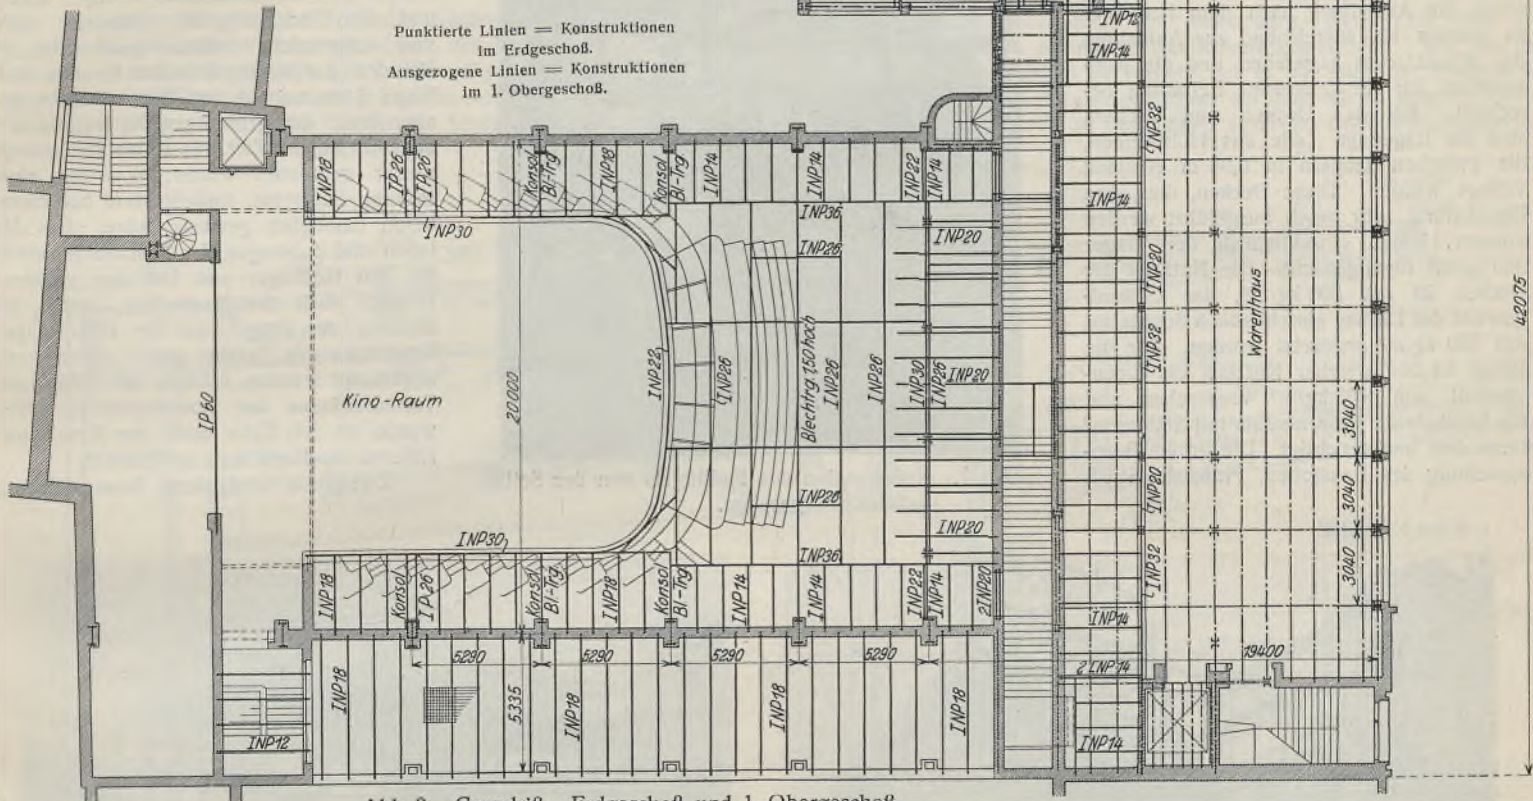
Grundriß. Erdgeschoß und 1. Obergeschoß.
